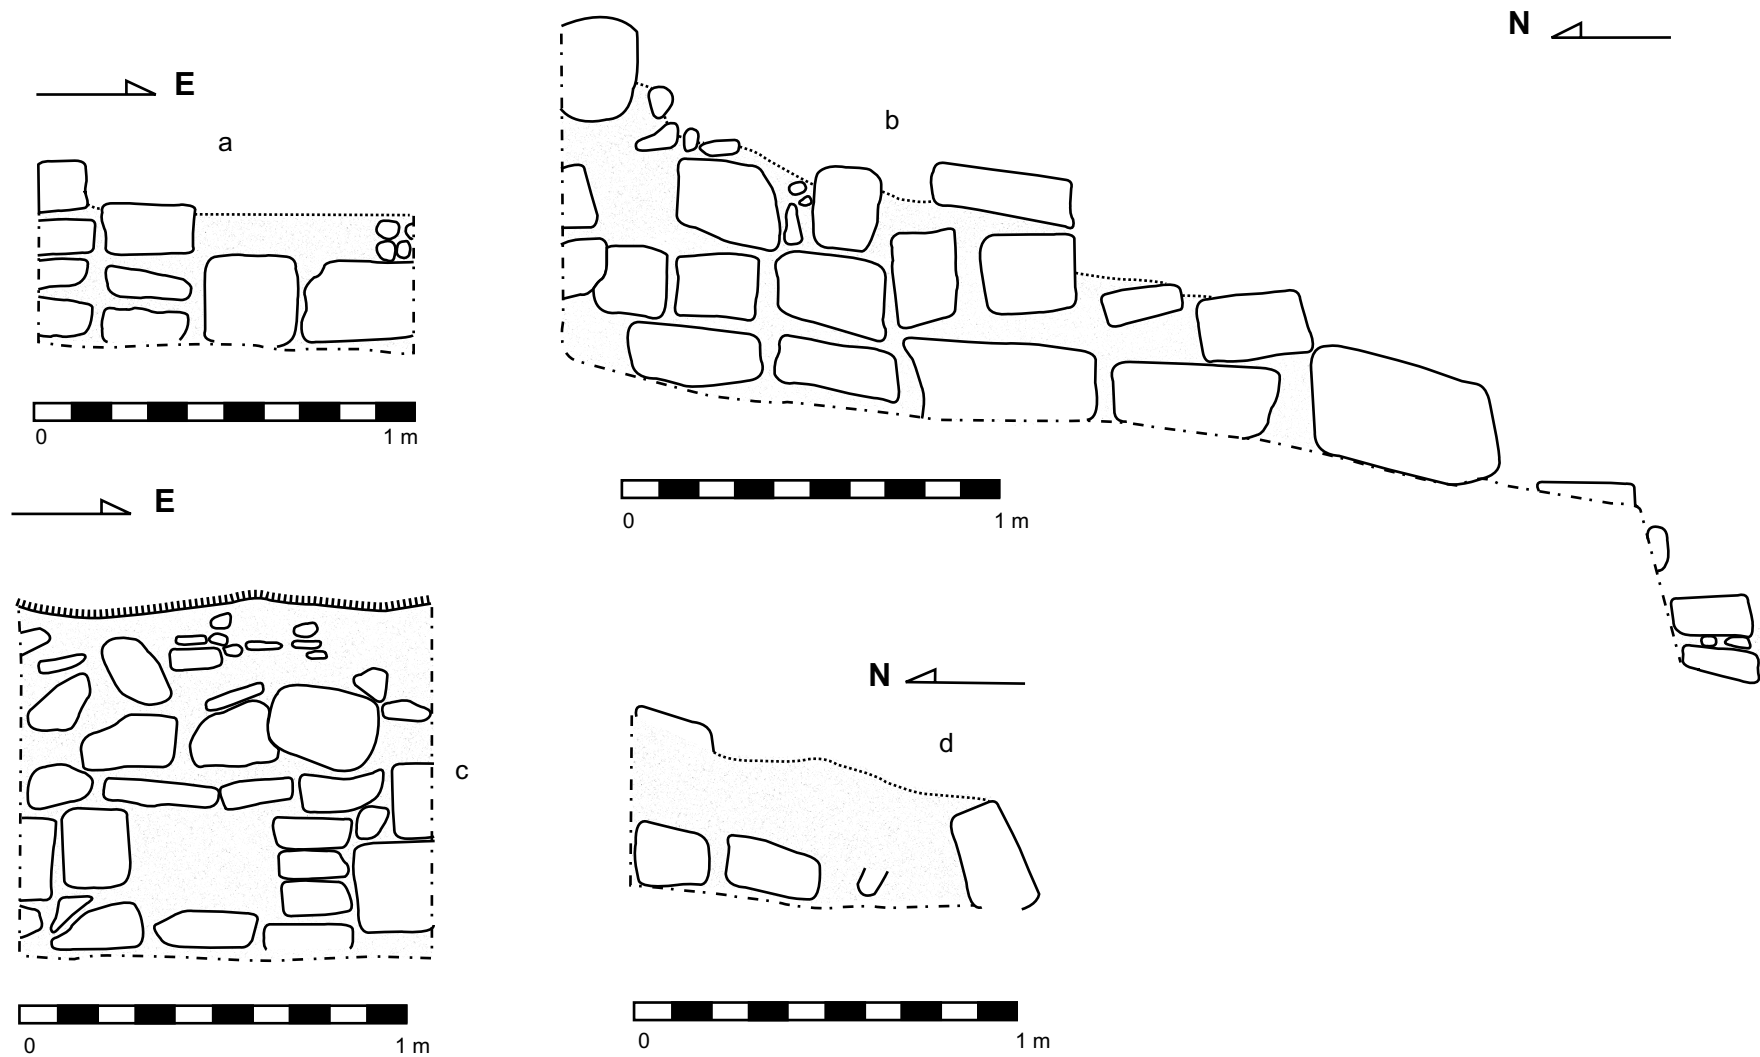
a) WK07B-21 Muro ubicado al centro de la Estructura L11-31 b) WK07B-20 Muro este de la Estructura L11-31
